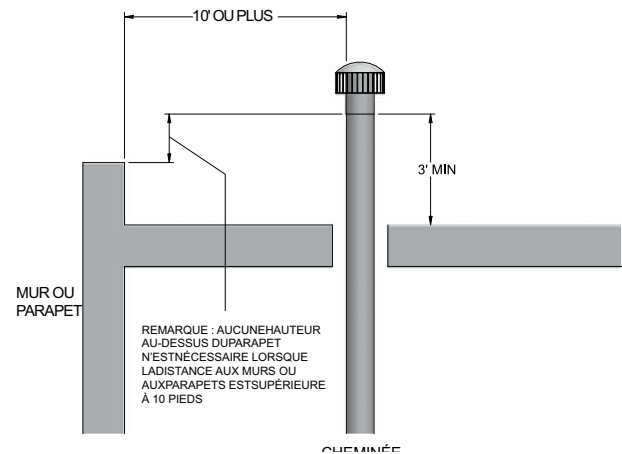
Terminaison de ventilation depuis un toit-terrasse - 10 pi. Ou plus du parapet
